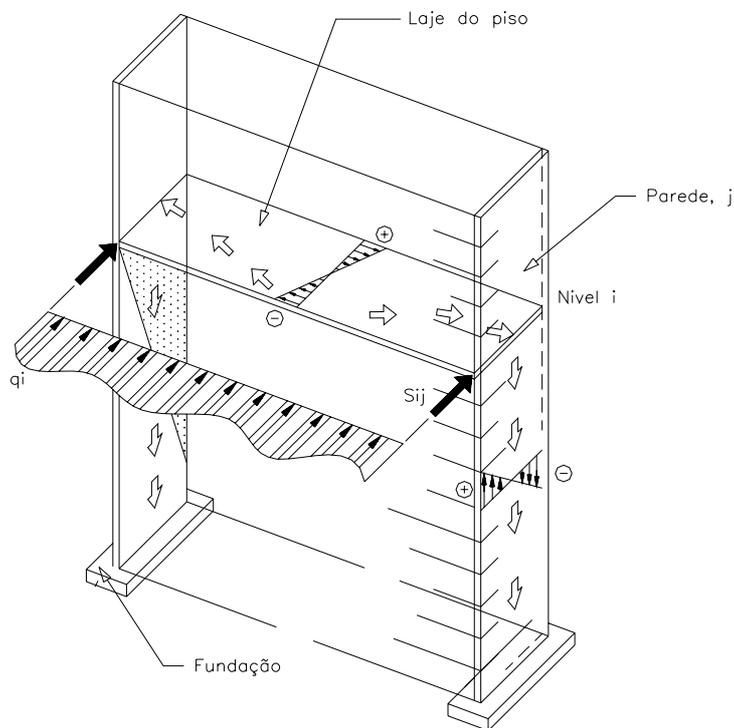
Transmissão das ações horizontais em edifícios em altura
